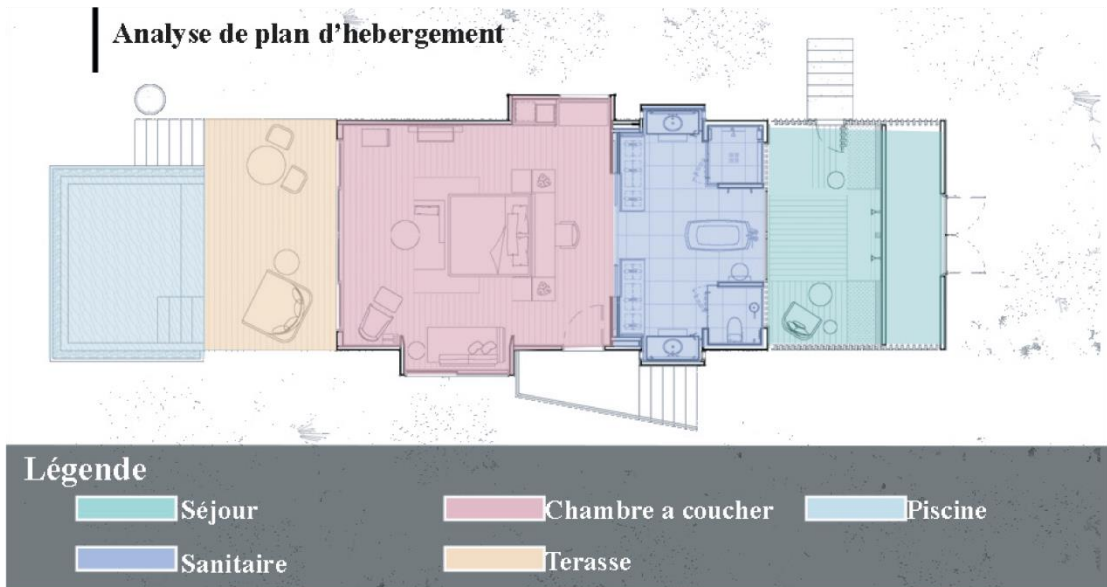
Plan d'hébergement, source : Archdaily, Traitée par : Auteurs, 2025
